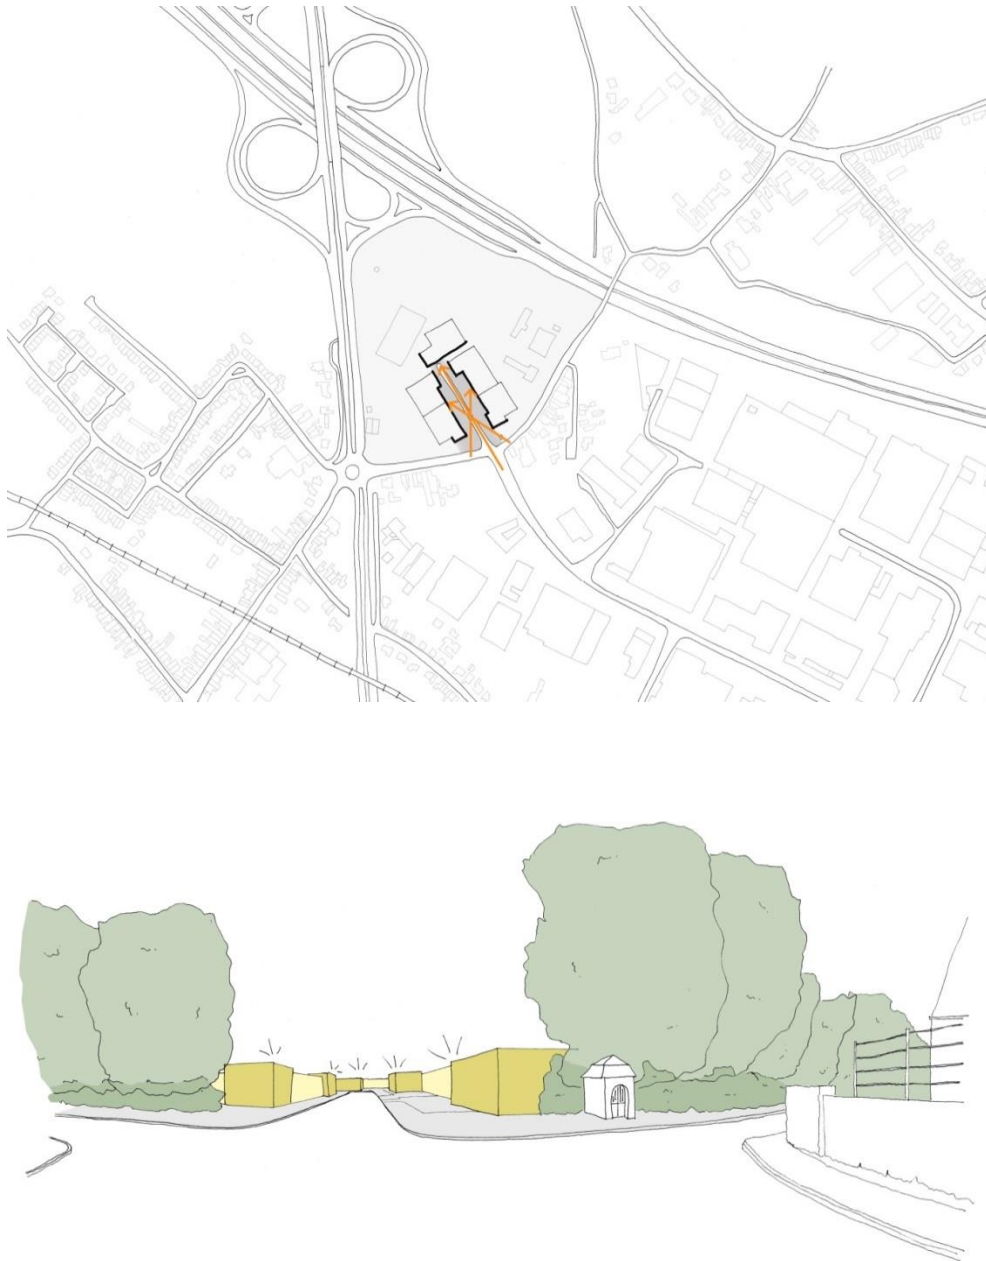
Centrale ontsluitingsweg als sluitstuk van bedrijventerrein
